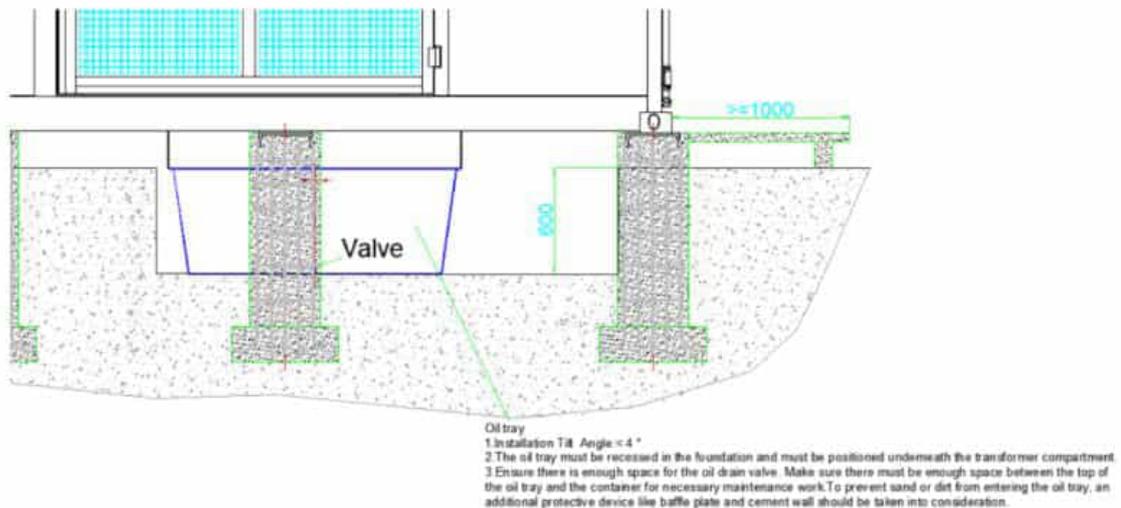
Detalle de cimentación con cubeto de aceite según fabricante
